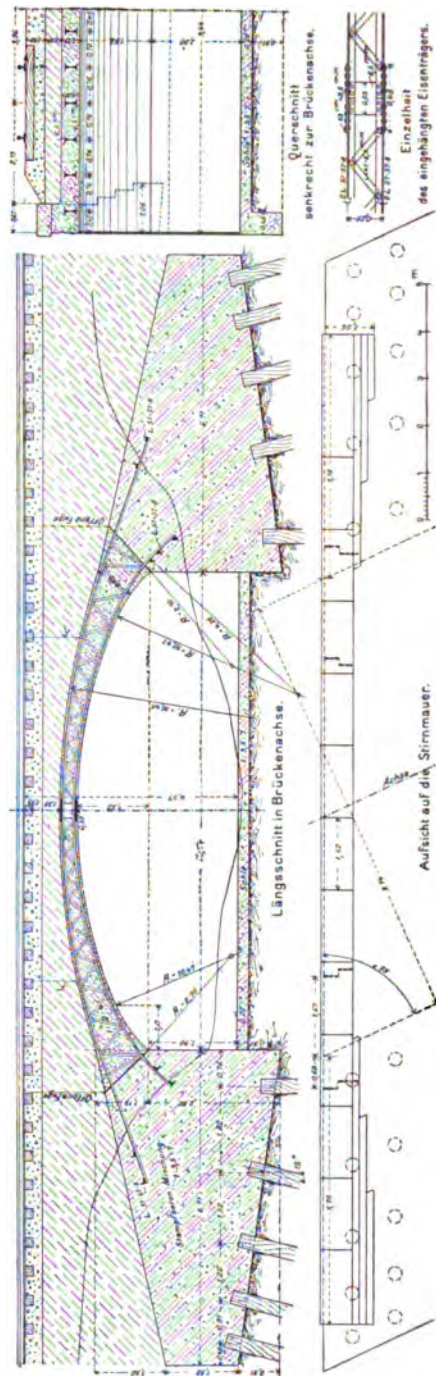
und 123. Eisenbahnbrücke nach System Molan.
